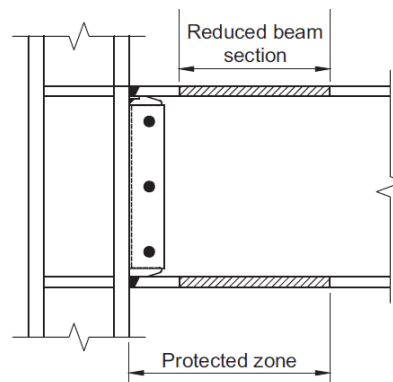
Vista frontal de conexión RBS (American Institute of Steel Construction, 2016).
